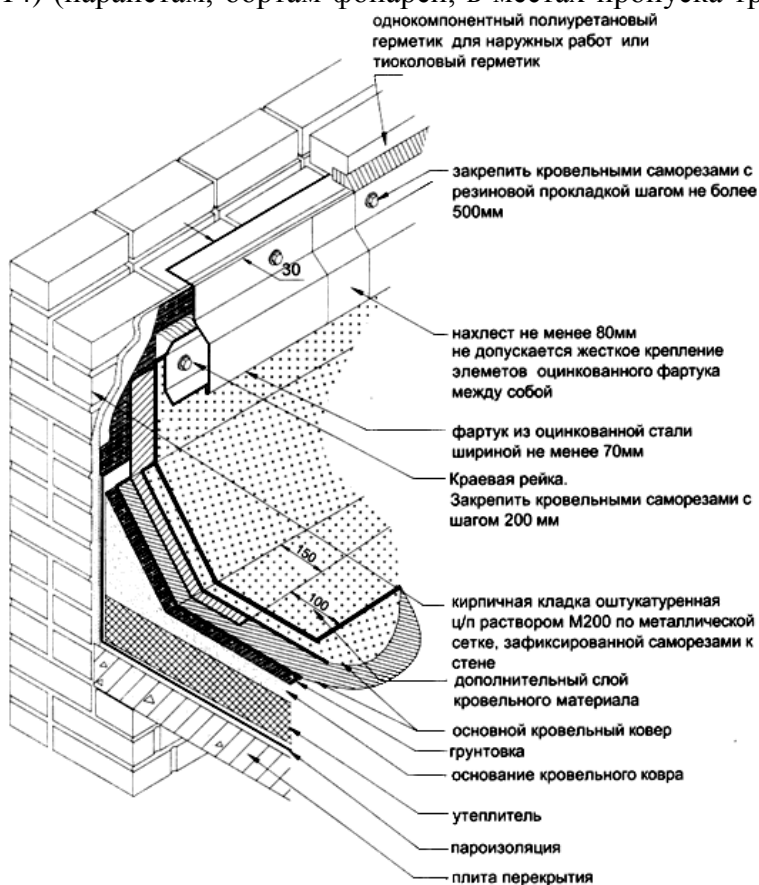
Примыкание кровельного ковра к вертикальной поверхности
